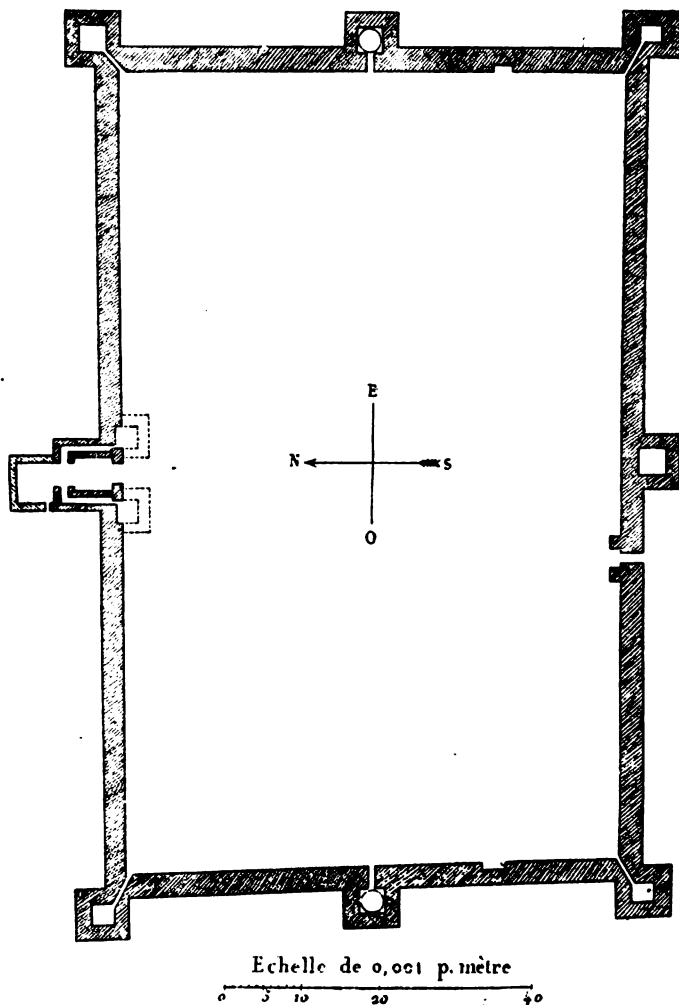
Plan de la forteresse byzantine de Timgad.
